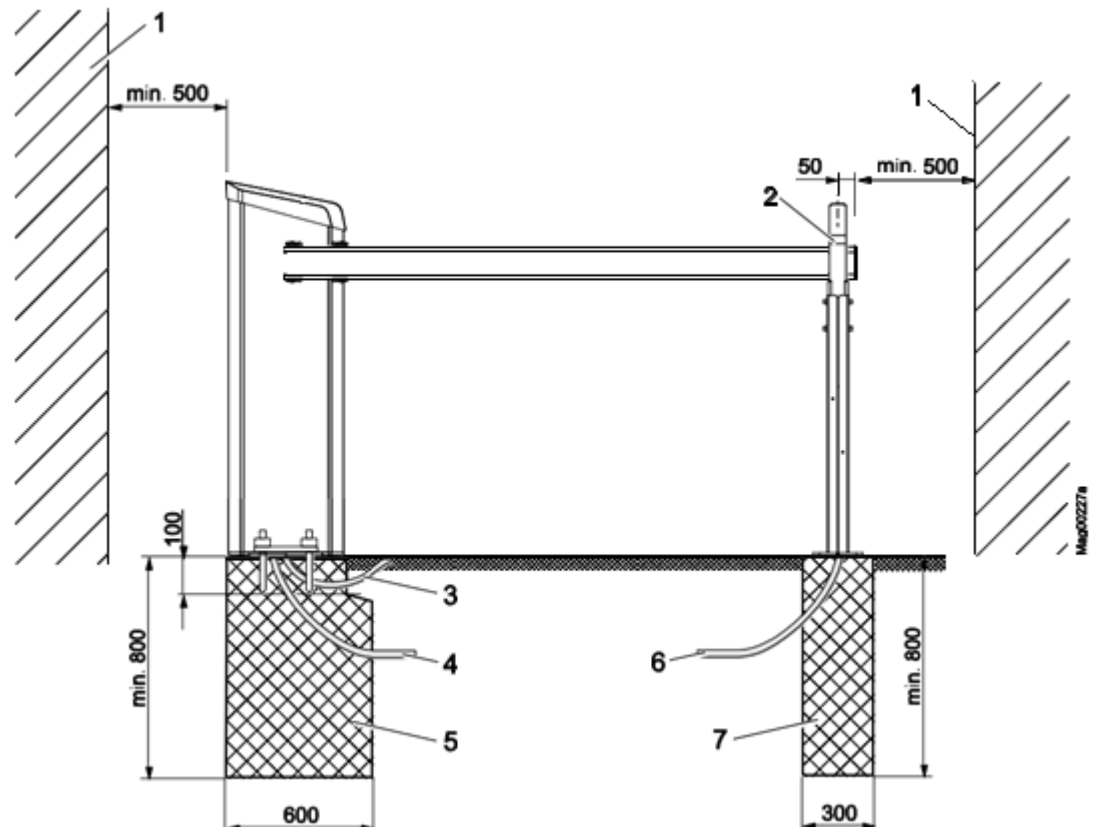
Montaje del sistema de barrera, representado aquí para el tipo "Access Pro H" (dimensiones en mm)
